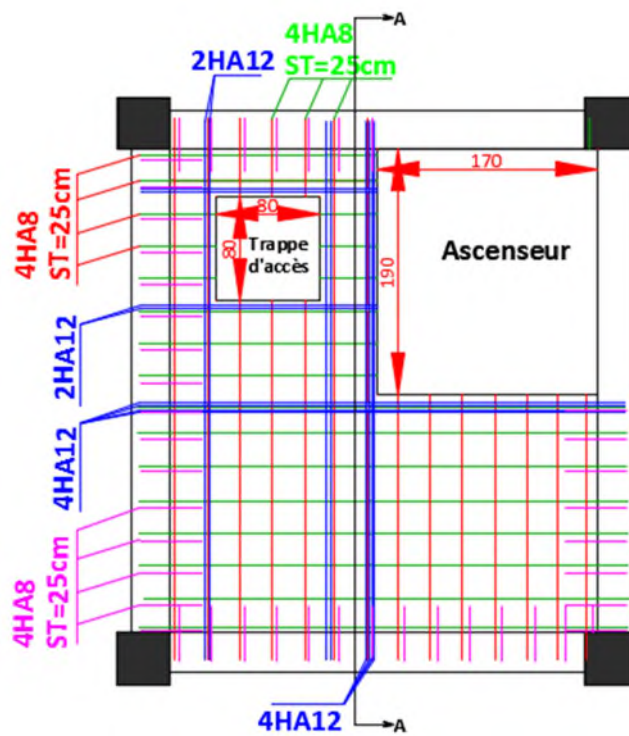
schémas de ferrailage de la dalle d'ascenseur
